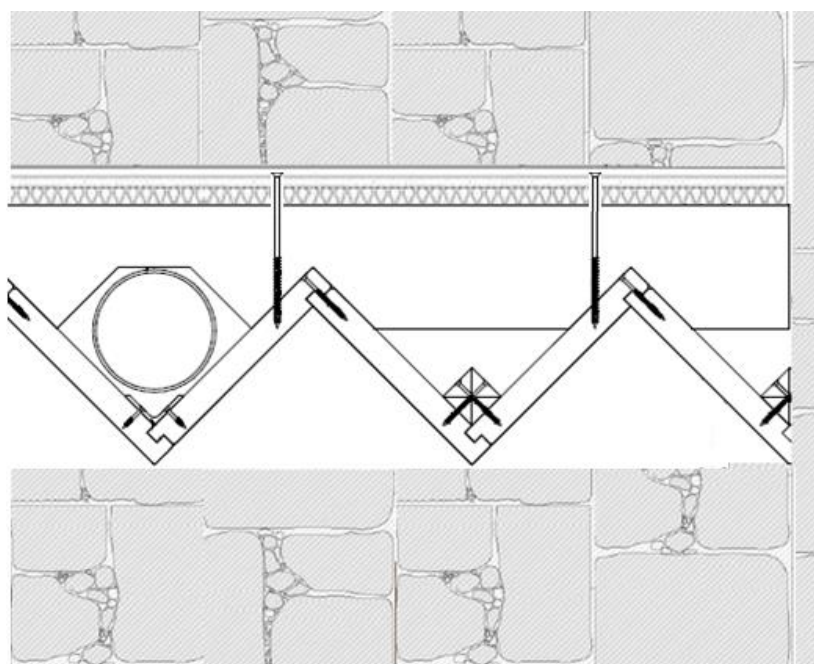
Corte pormenorizado da solução pré-fabricada do sistema “Wenus” (Autoria própria)
